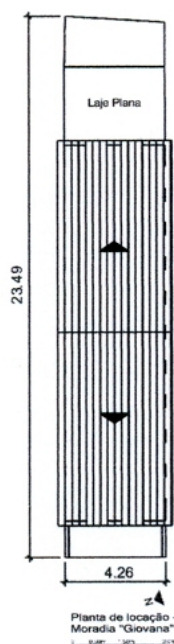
Planta de locação - moradia "Giovana"
